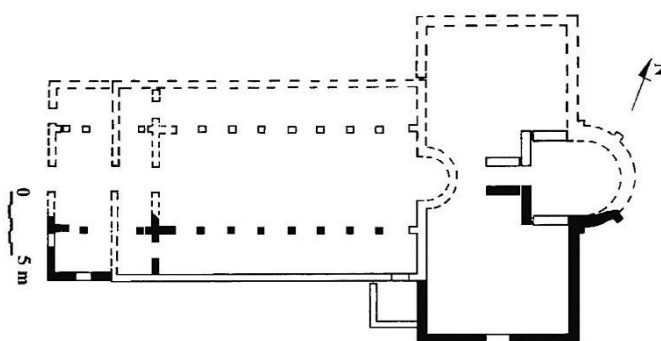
Pautalia*, Basiliken Nr. 2 und 3, Grundriss
